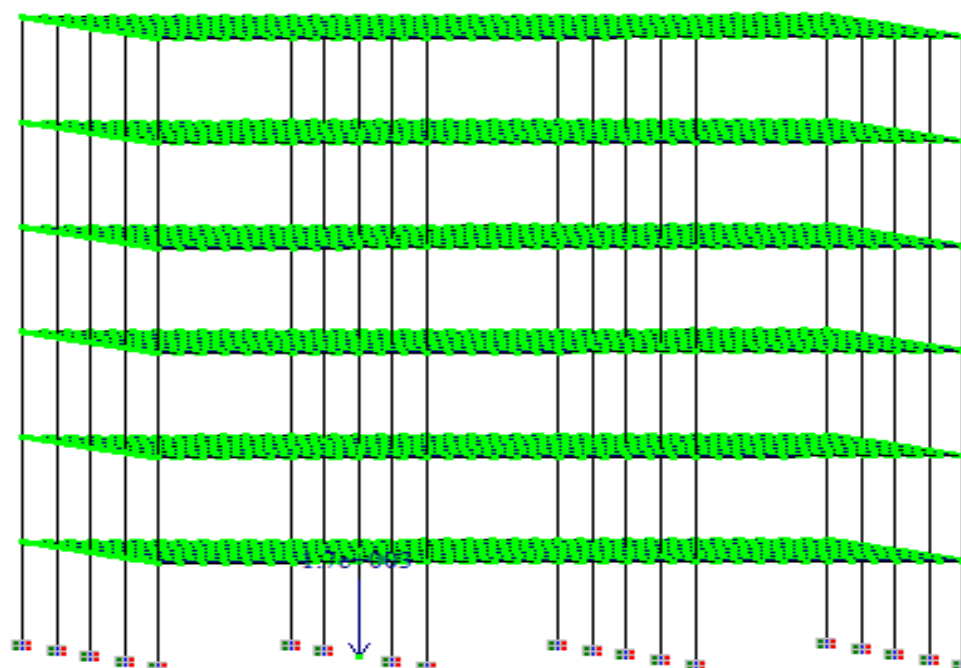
Schéma illustratif du modèle d'étude du bâtiment avec planchers sans hourdis à 6 niveaux avec un chargement vertical sur le poteau intermédiaire
